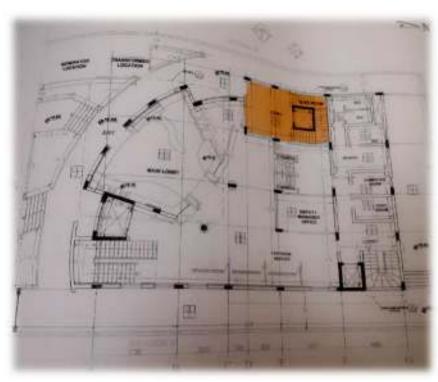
مسقط أفقي مركز كوجنغ الثقافي
